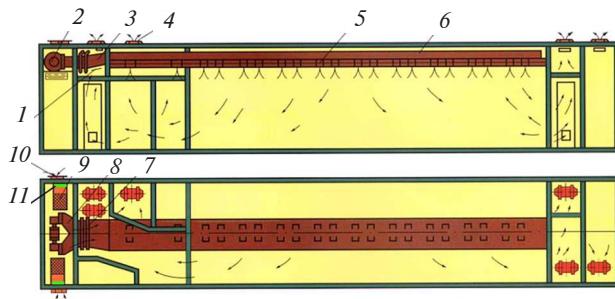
Схема механической приточной вентиляции без рециркуляции воздуха
